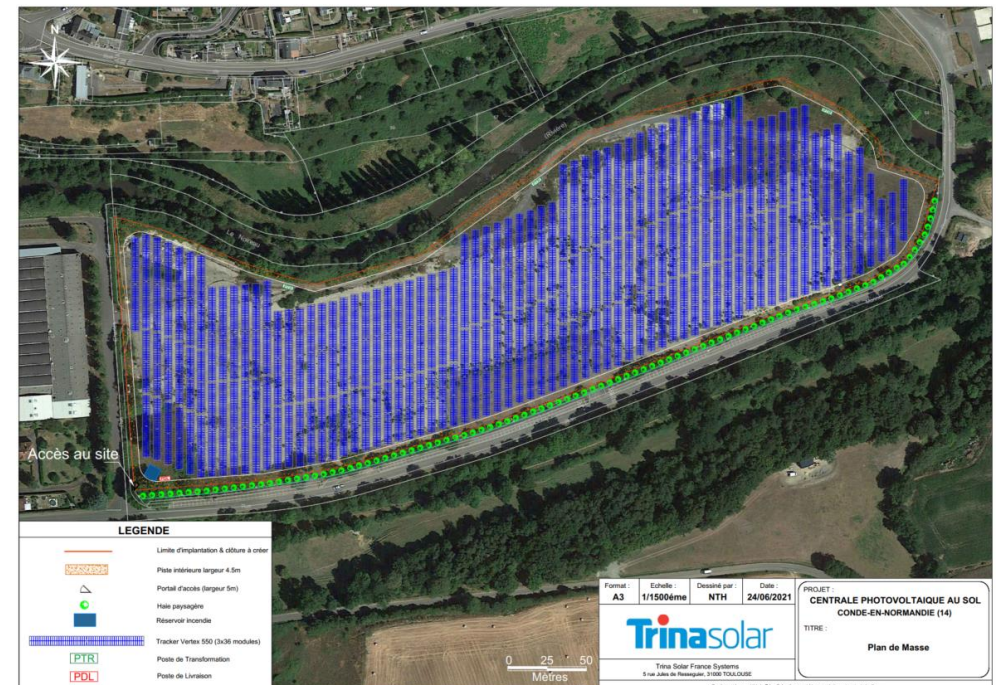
Variante V1 du plan d'implantation (Source : Trina Solar)
